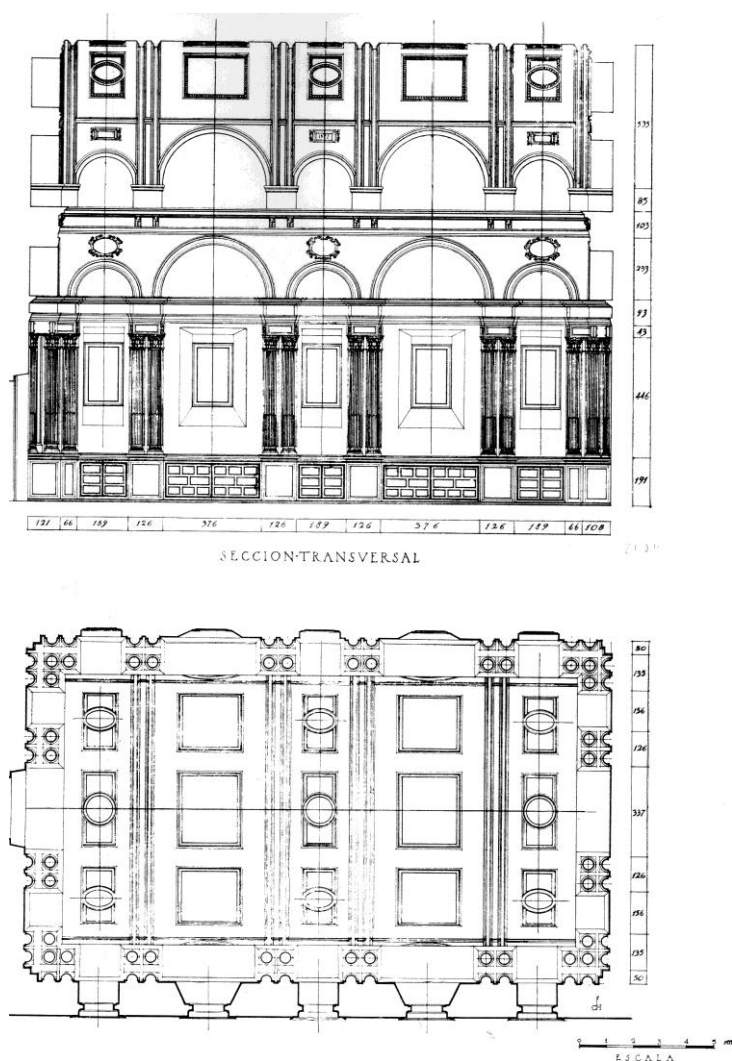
Sacristía de la Catedral de Jaén. Planta y alzado según Chueca (1971)
